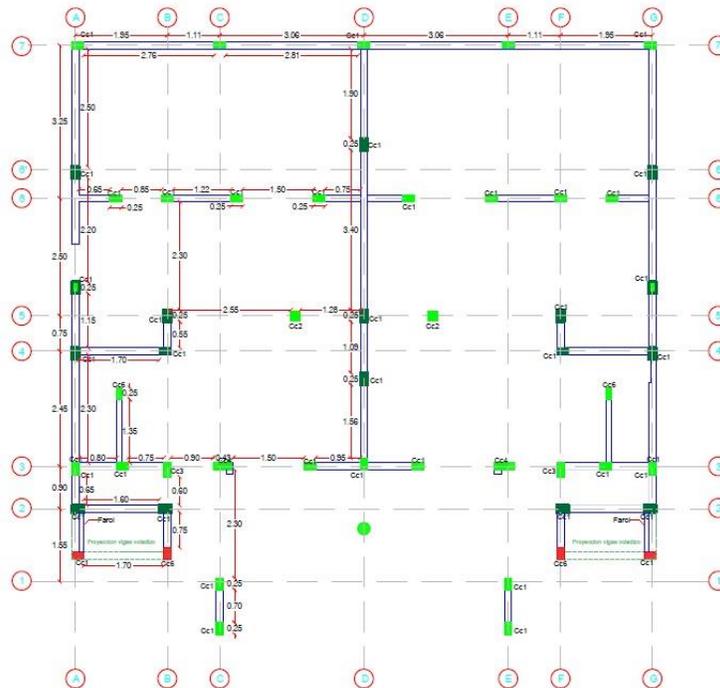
Diseño Estructural, Columnas y Mampostería Primer Nivel. Fuente Diseño Ing. Carlos Ariel Hurtado.
